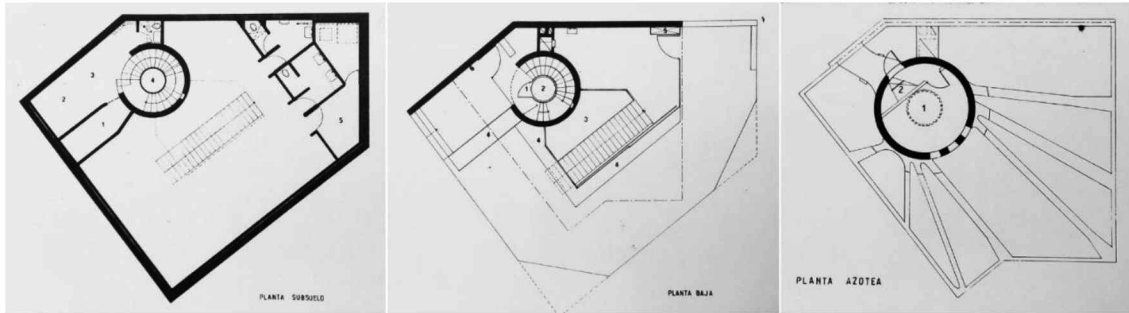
Planta de subsuelo, planta baja y planta de cubierta del edificio El Pilar.
